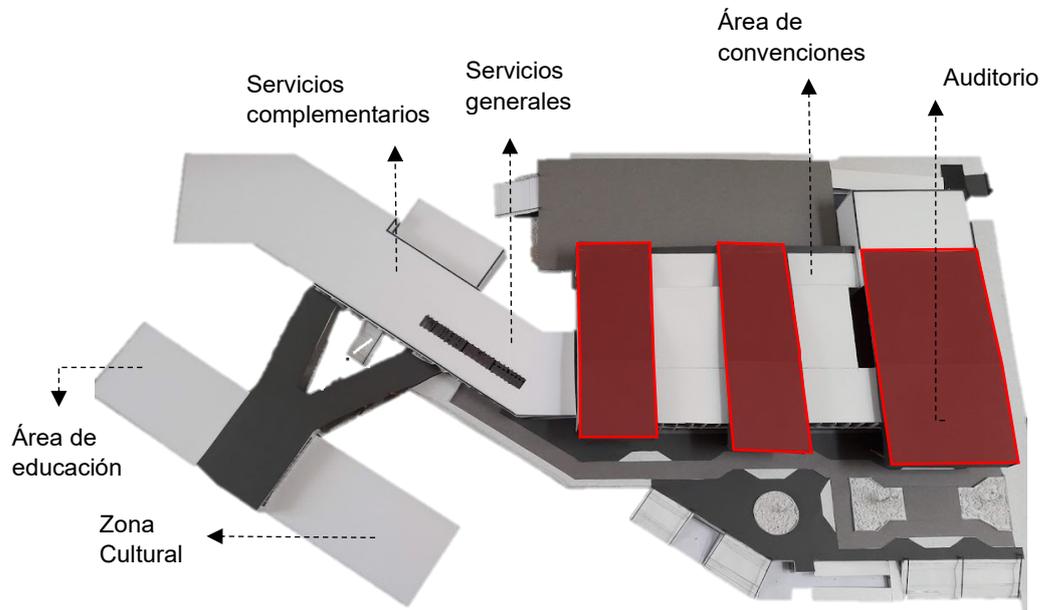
Planteamiento Volumétrico, vista en planta del complejo.
